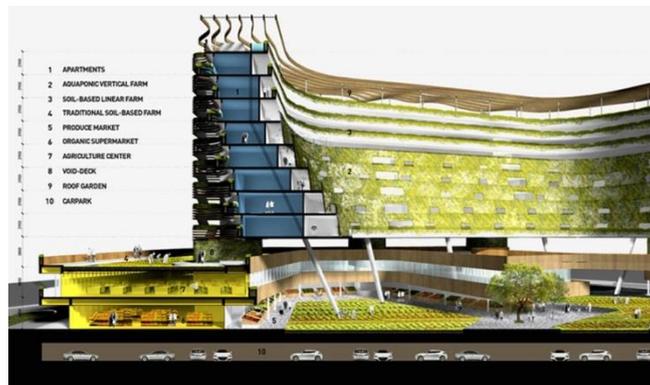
Проект жилого дома «Домашняя ферма», бюро SPARK Architects, 2014 г.
